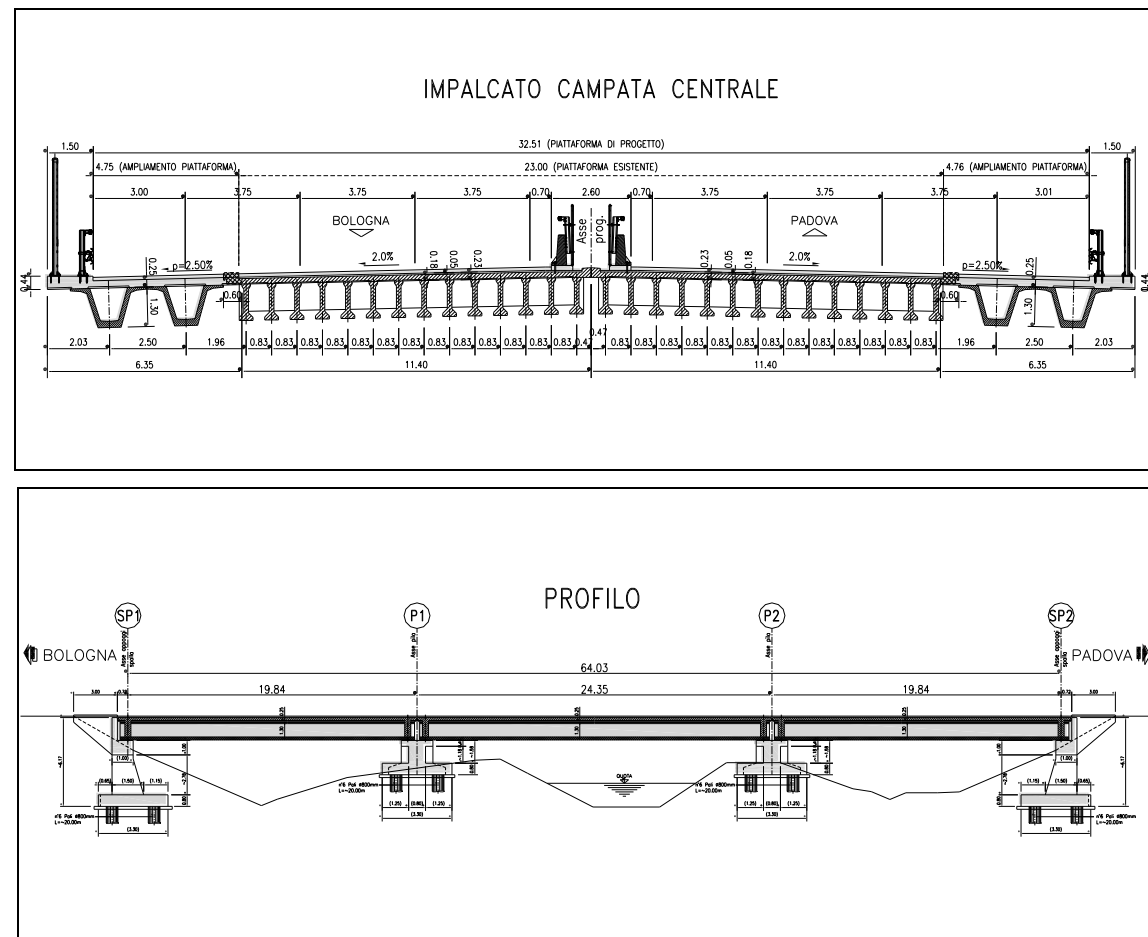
Sezione dell'impalcato e profilo del ponte sul canale Rivella
